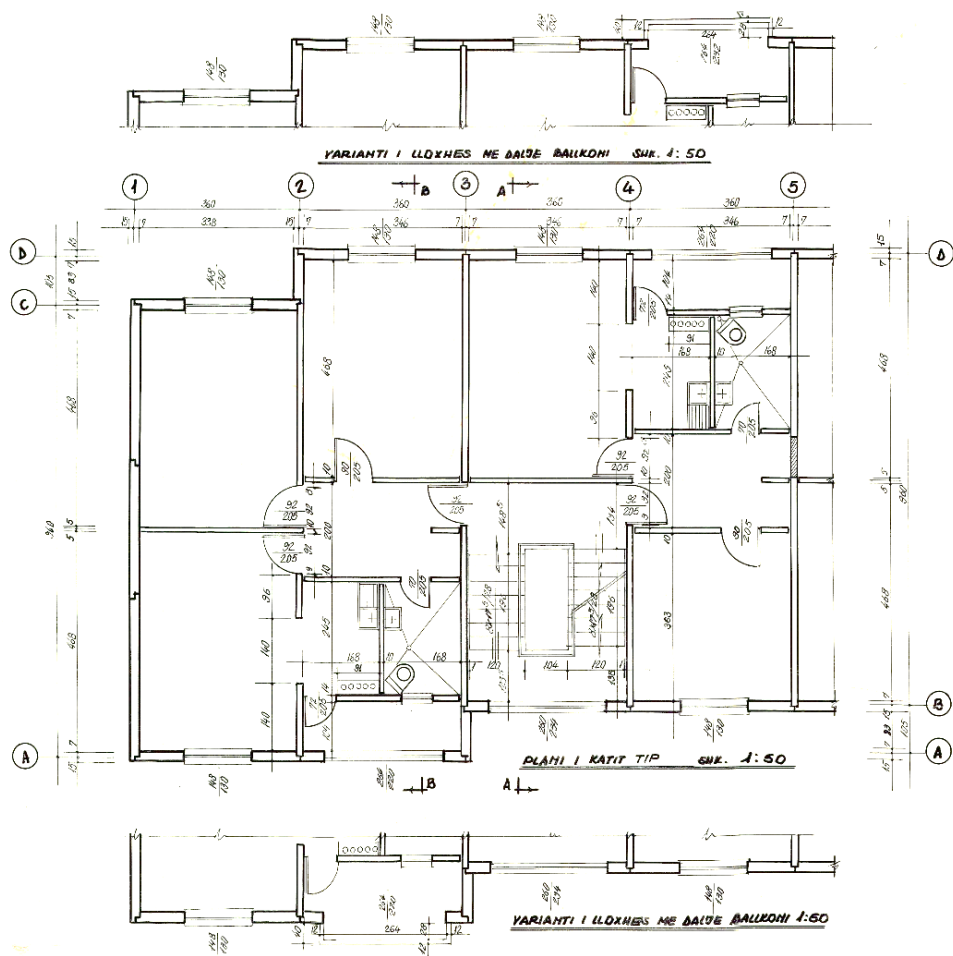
Pianta del Modulo 1a, variante con loggia e balcone, I.S.P. n. 1, 1980 [AQTN]
